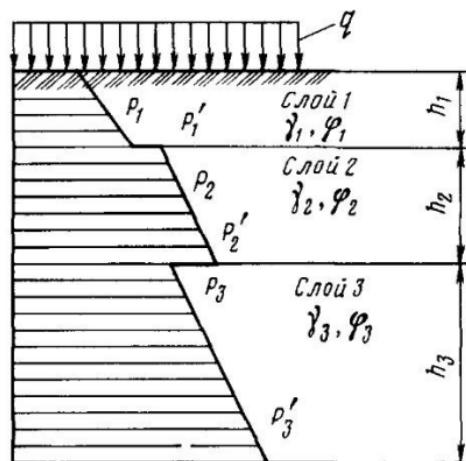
Схема для определения активного давления грунта из нескольких слоев песка или супеси на стенку ограждения
